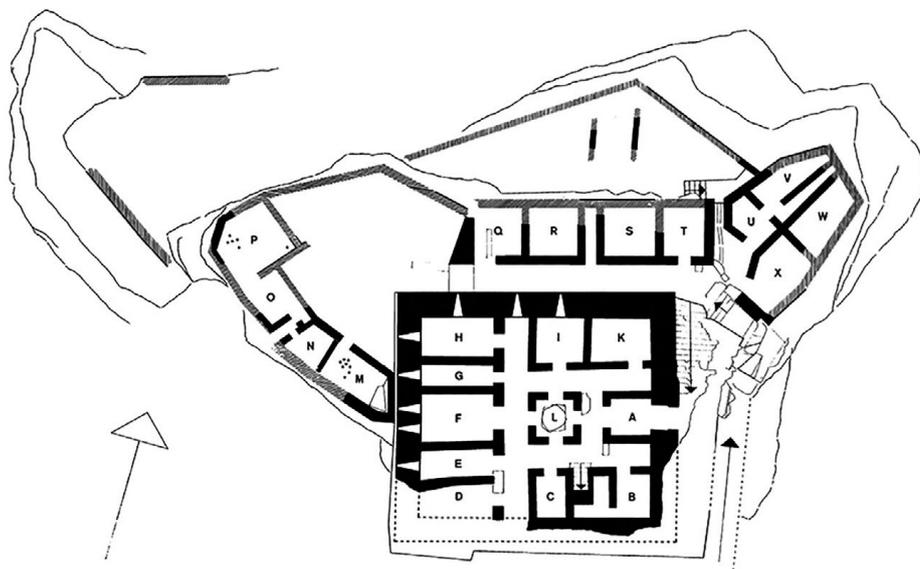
Planta de *Castelo da Lousa* (Wahl, 1985: fig. 3)
